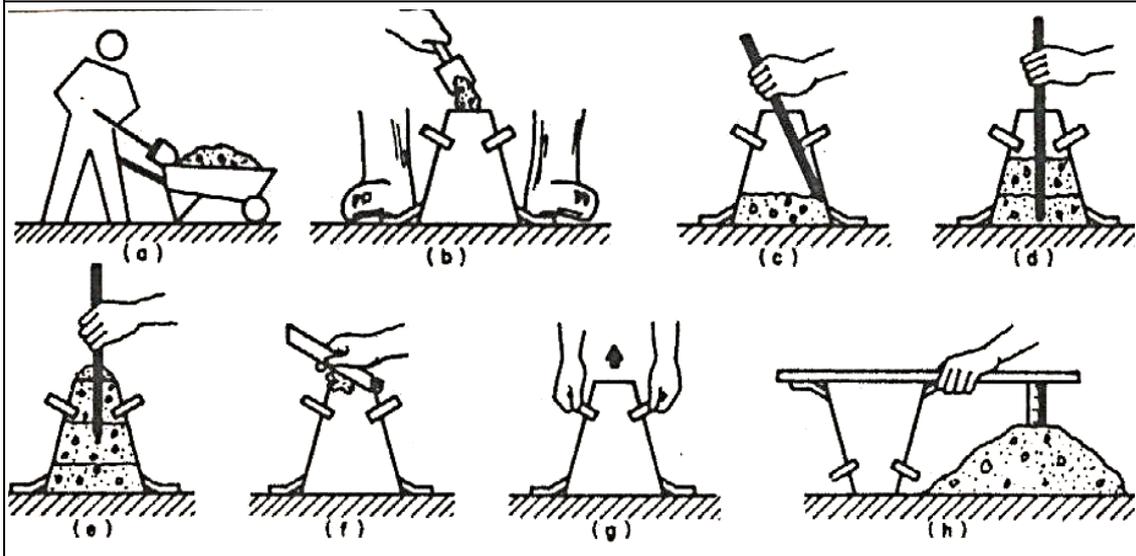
Se esquematiza la secuencia de la prueba de asentamiento o slump.
